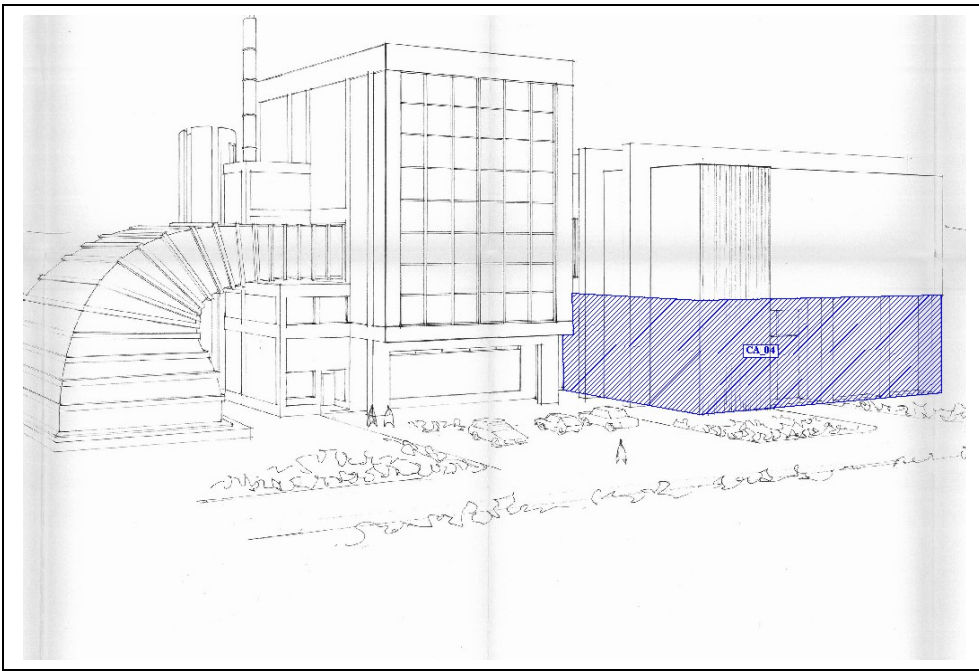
individuazione dell' intervento CA 04 (disegno del prospetto esterno)
